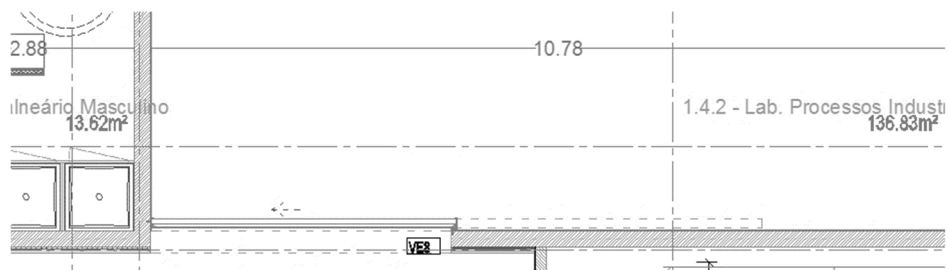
Pormenor da planta mostrando a parede exterior do balneário e da Oficina 1.4.2
